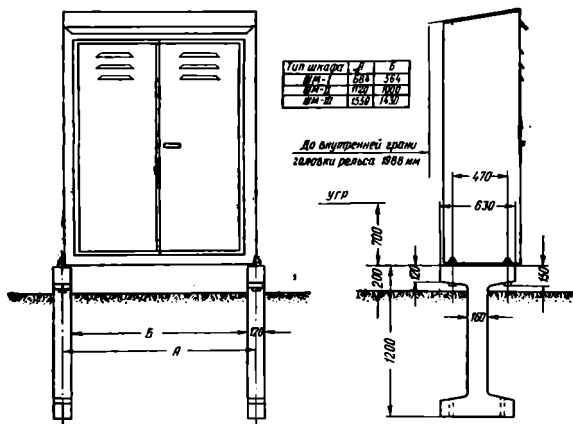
Установка релейного шкафа на железобетонном фундаменте
